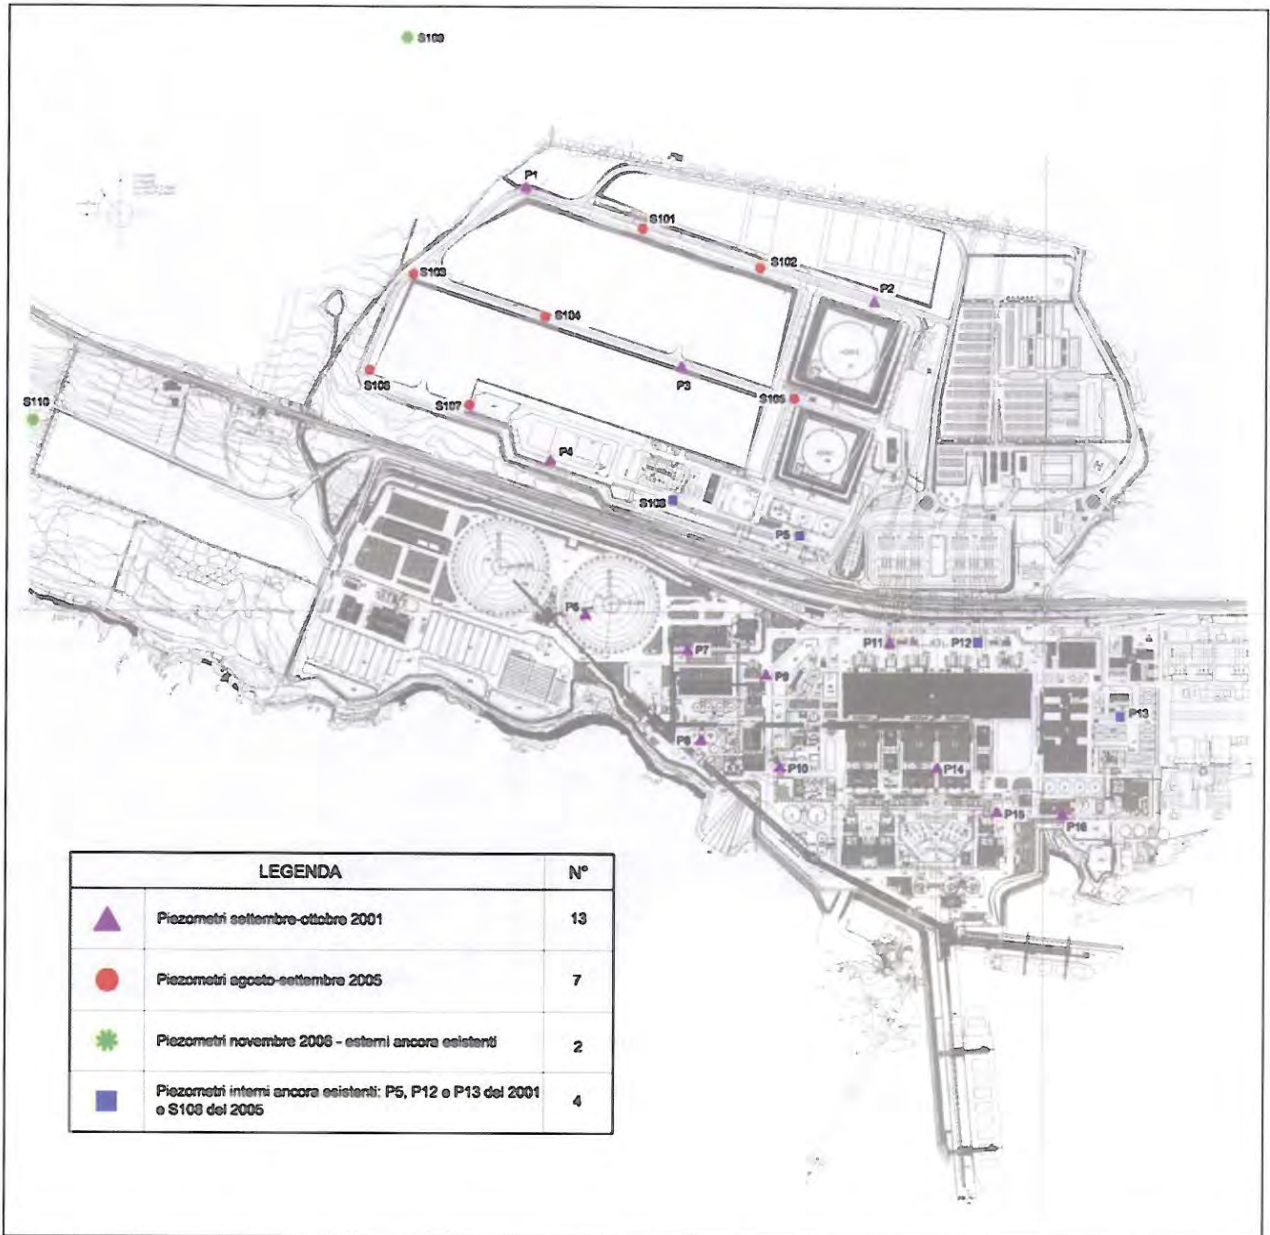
Planimetria della Centrale con l’ubicazione di tutti i piezometri installati nel corso degli anni (dal 2001)
